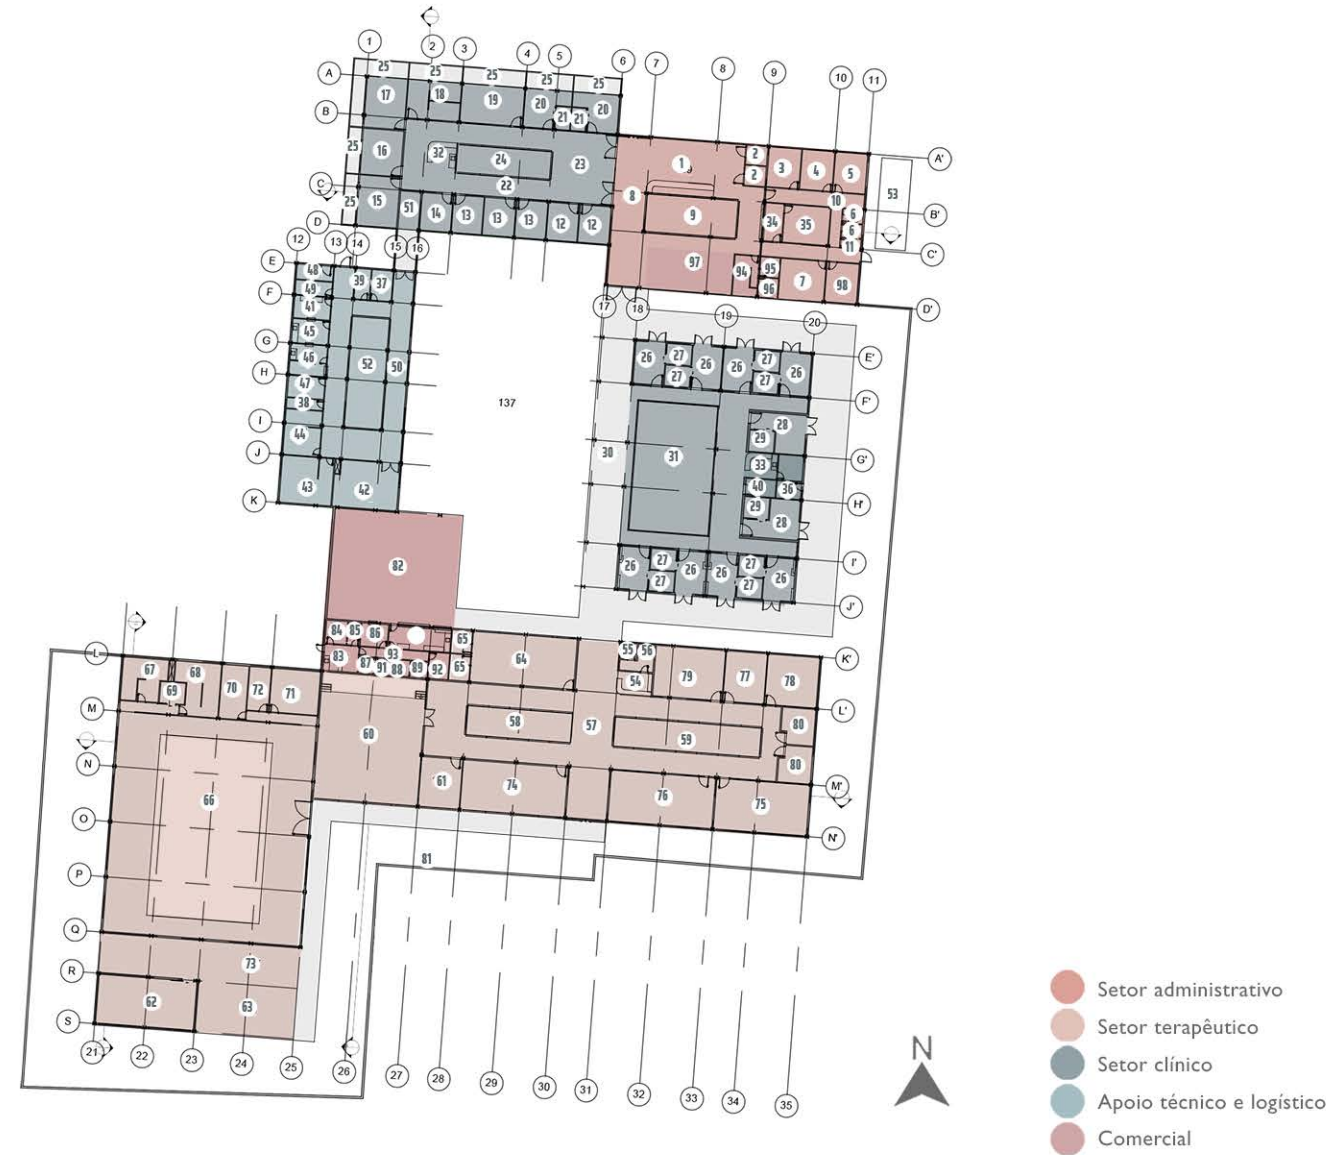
Planta baixa com eixos estruturais e identificação dos ambientes. Escala: 1:750. Imagem autoral.
